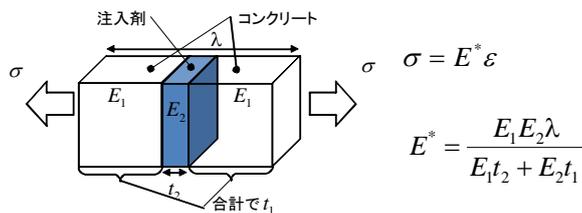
ひび割れ注入コンクリートの引張剛性モデル
